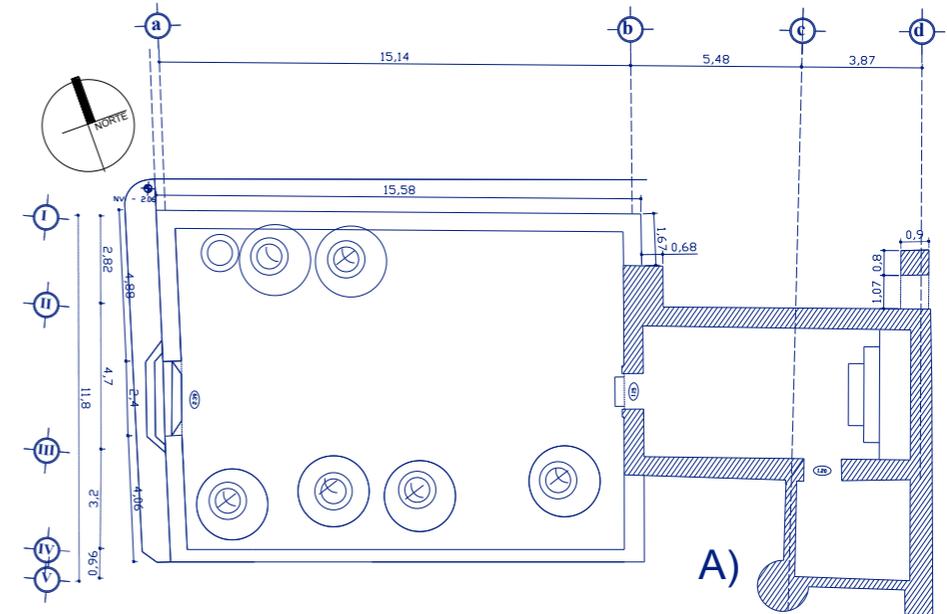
Planta arquitectónica de la Capilla de San Antonio de Padua
